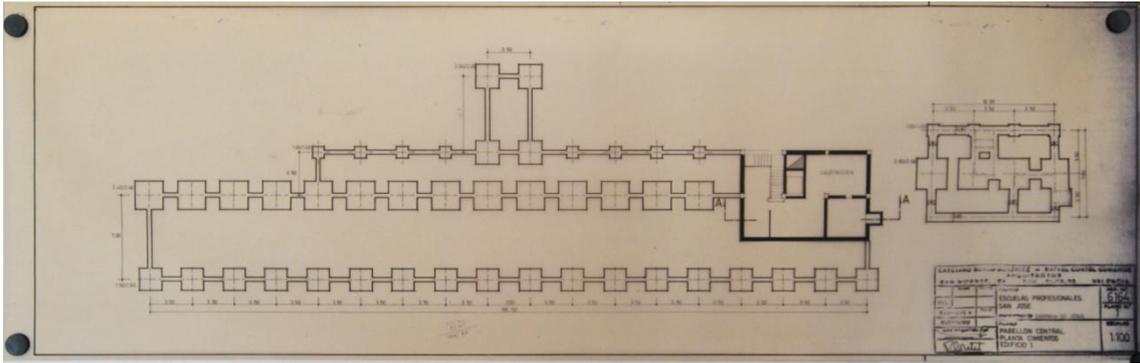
Plano de cimentación edificio administrativo. *Archivo Escuelas San José.
